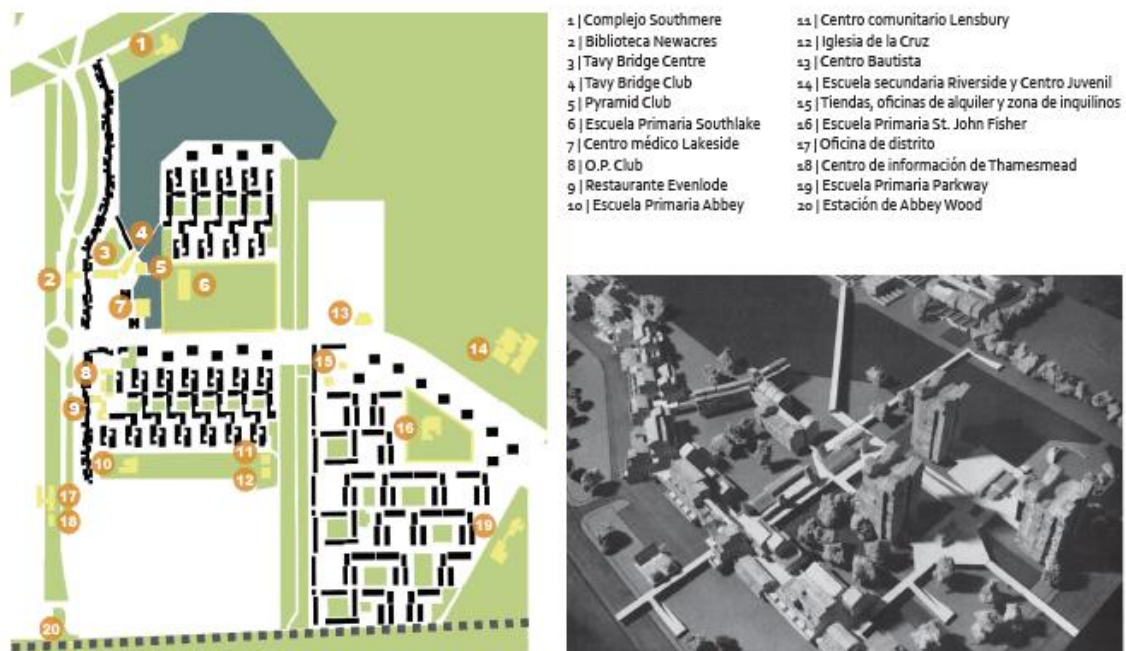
Dotaciones de las Fases I y II. Maqueta con el centro, Tavy Bridge, las viviendas en hilera y las torres.
